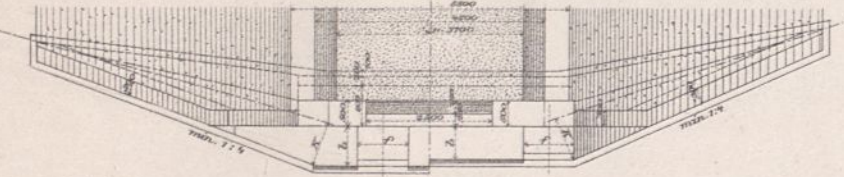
Grundriss des Grundmauerwerks.
